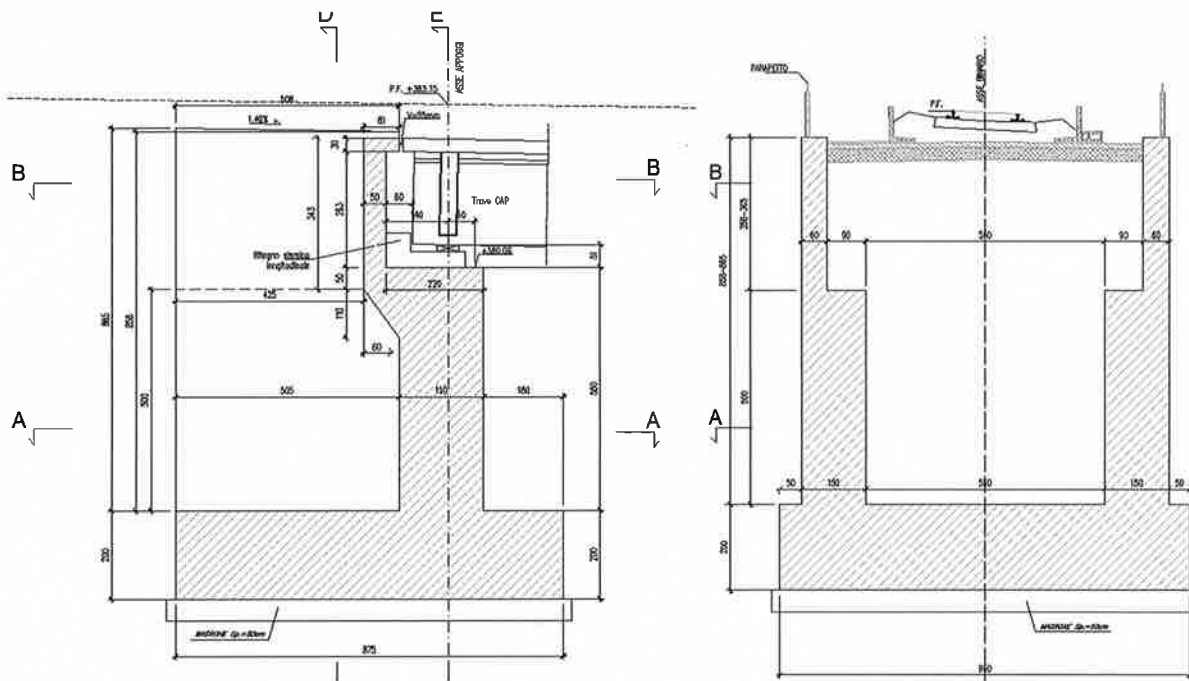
Sezione longitudinale e trasversale Bonorva VI03
